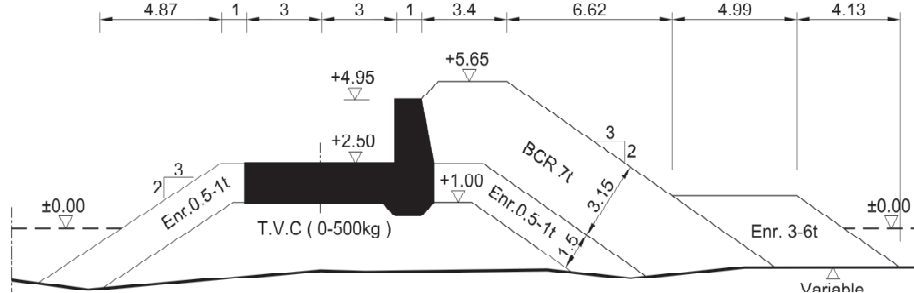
Coupe transversale du profil courant de la jetée secondaire
